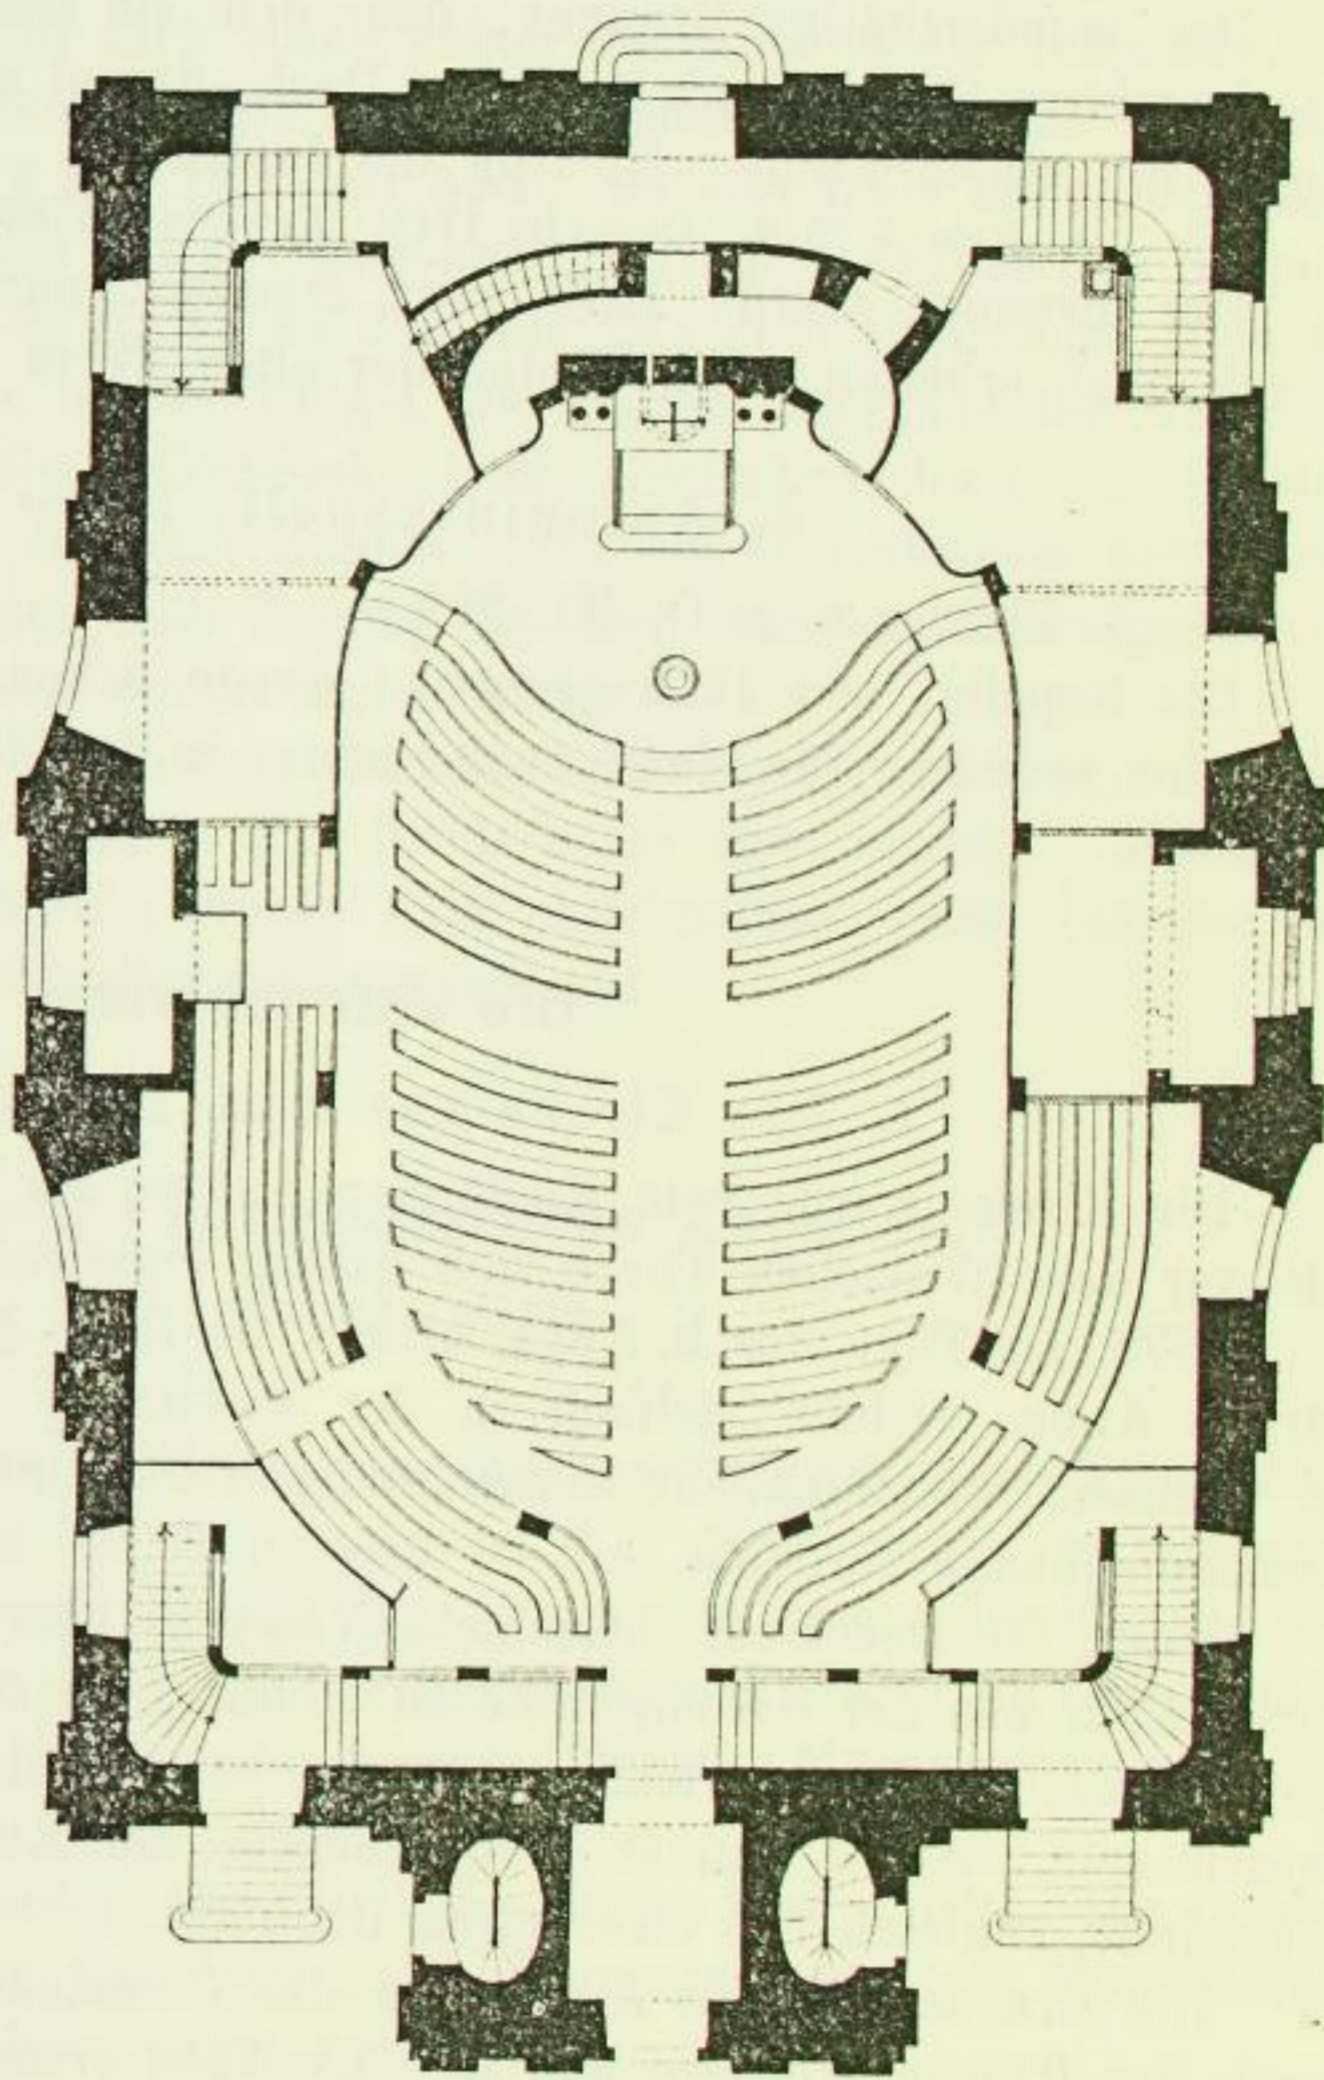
Annenkirche, Grundriss des Erdgeschosses.
